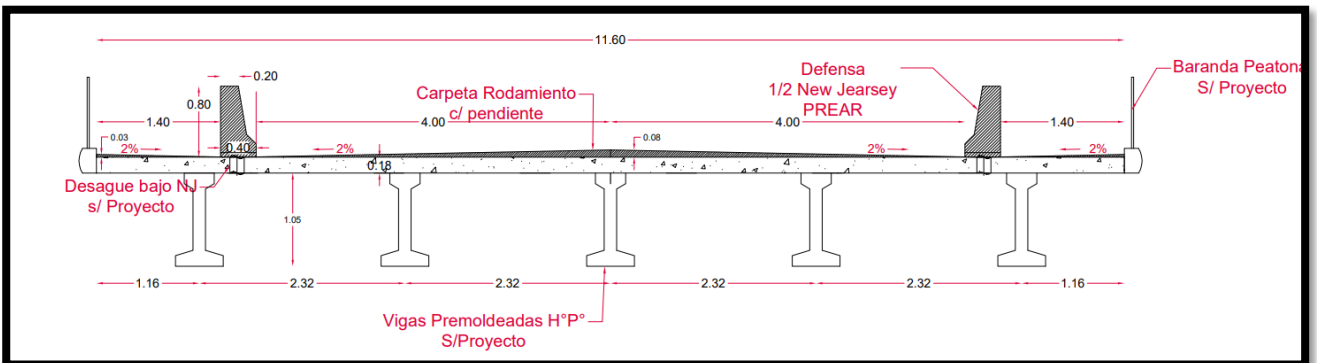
Puente en corte transversal. Fuente: Elaboración propia
